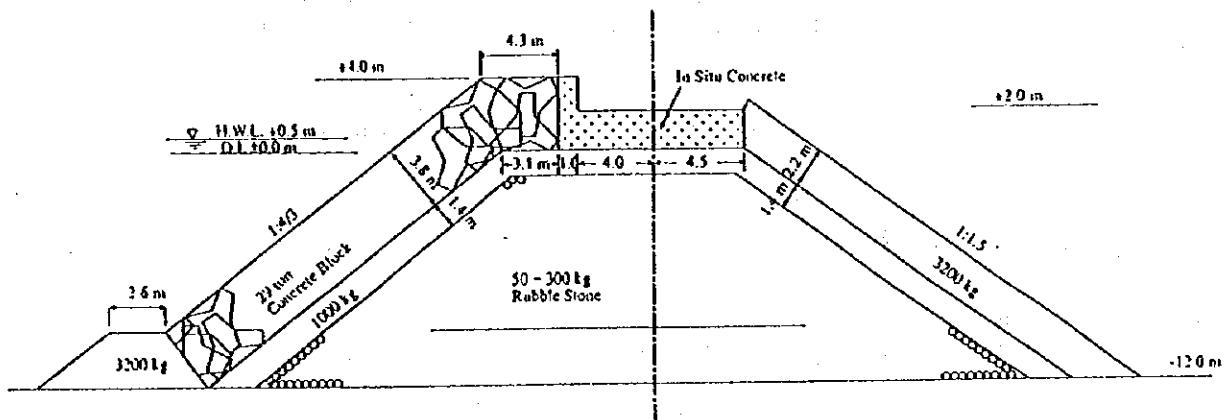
防波堤標準断面図-捨石堤(-12.0m)
